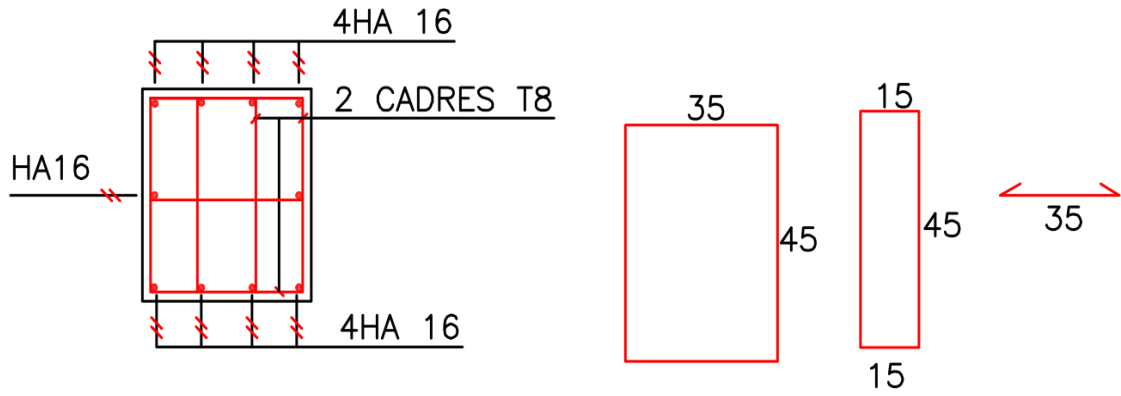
Coupe de ferrailage des poteaux 50×40 cm²
